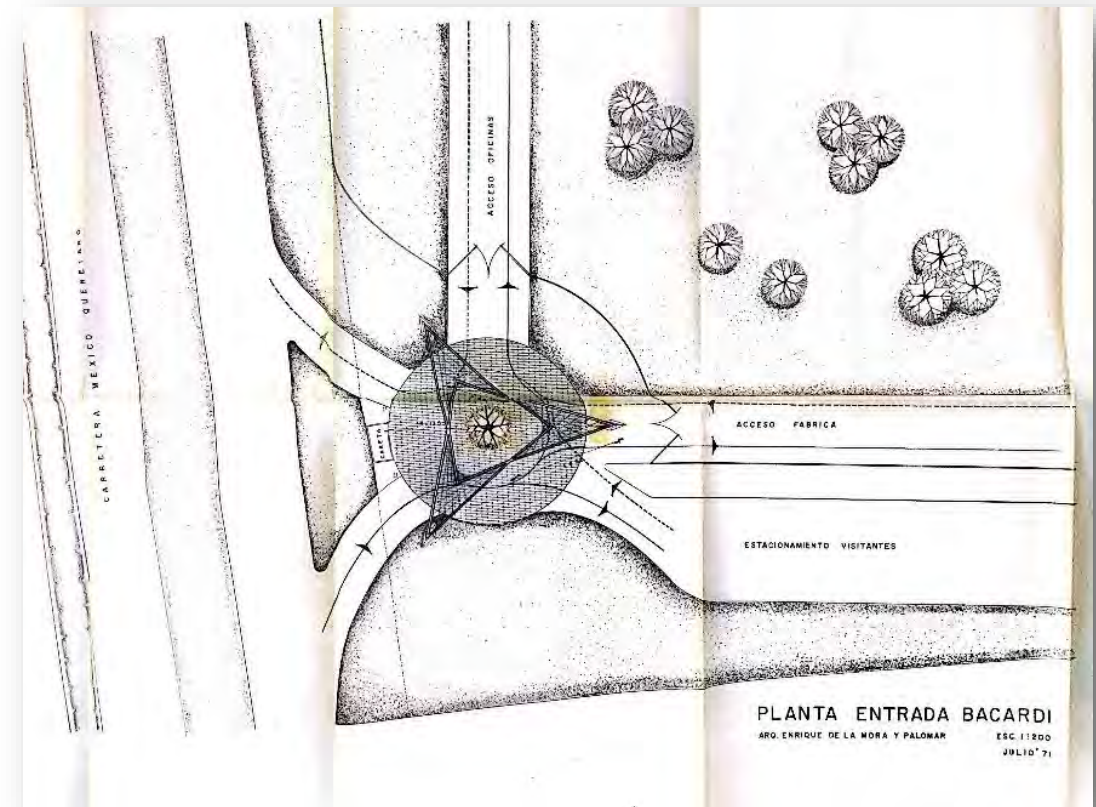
Planta de Estructura de acceso conjunto Bacardí con árbol al centro
